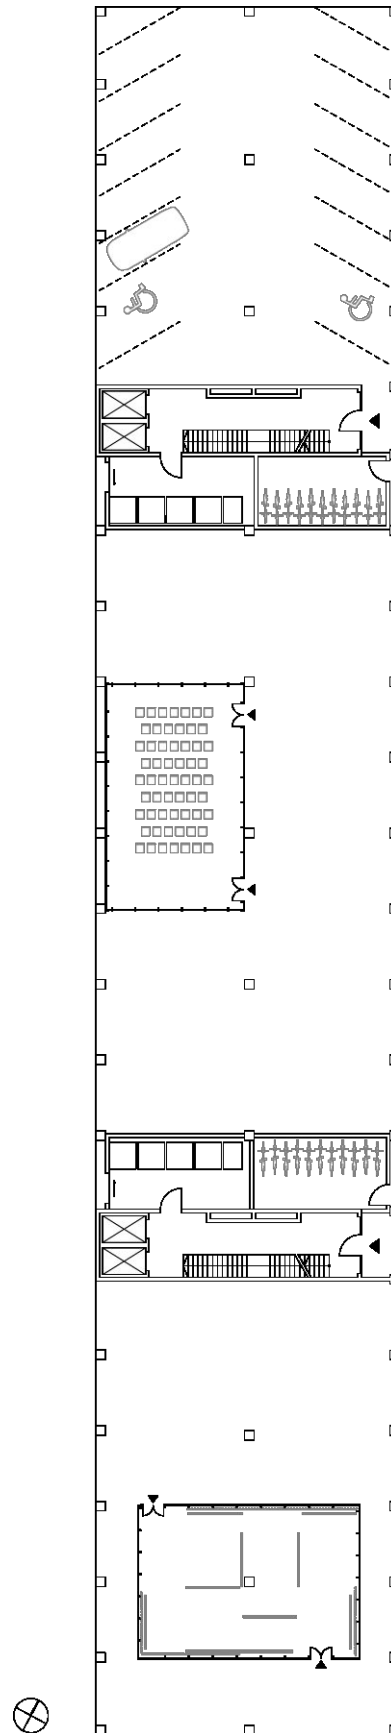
Grundriss 1. Obergeschoss:
